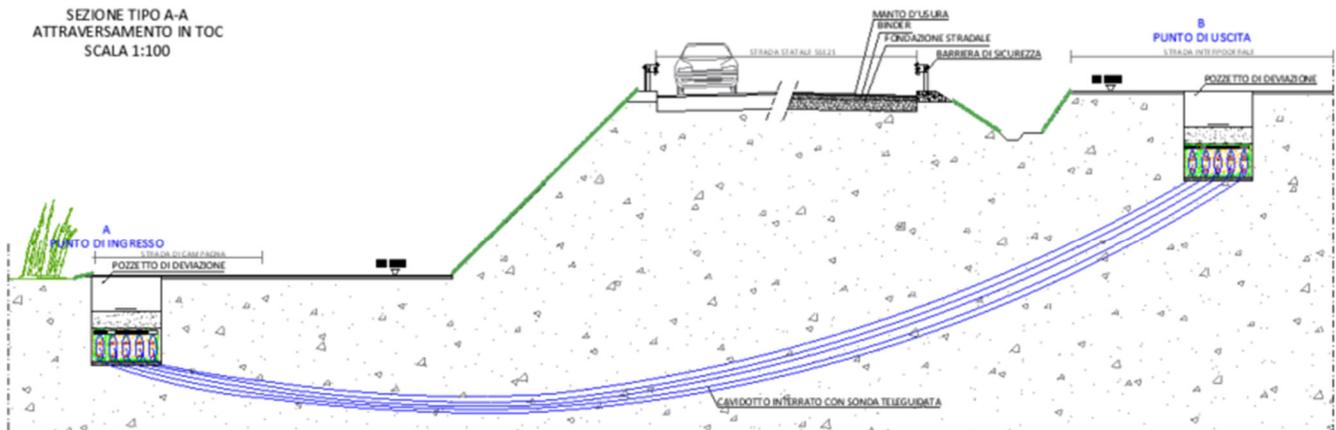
Sezione tipologica dell'attraversamento in TOC al di sotto del rilevato stradale
